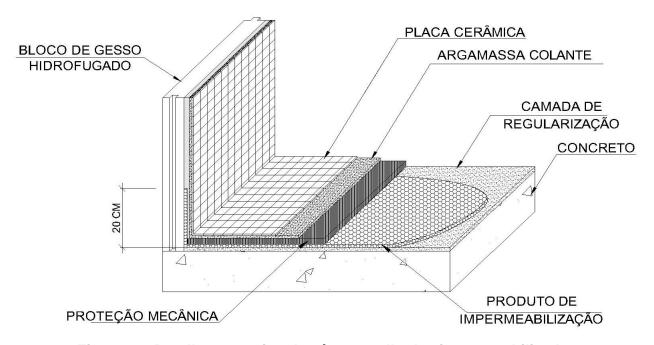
Detalhe executivo das áreas molhadas impermeabilizadas
